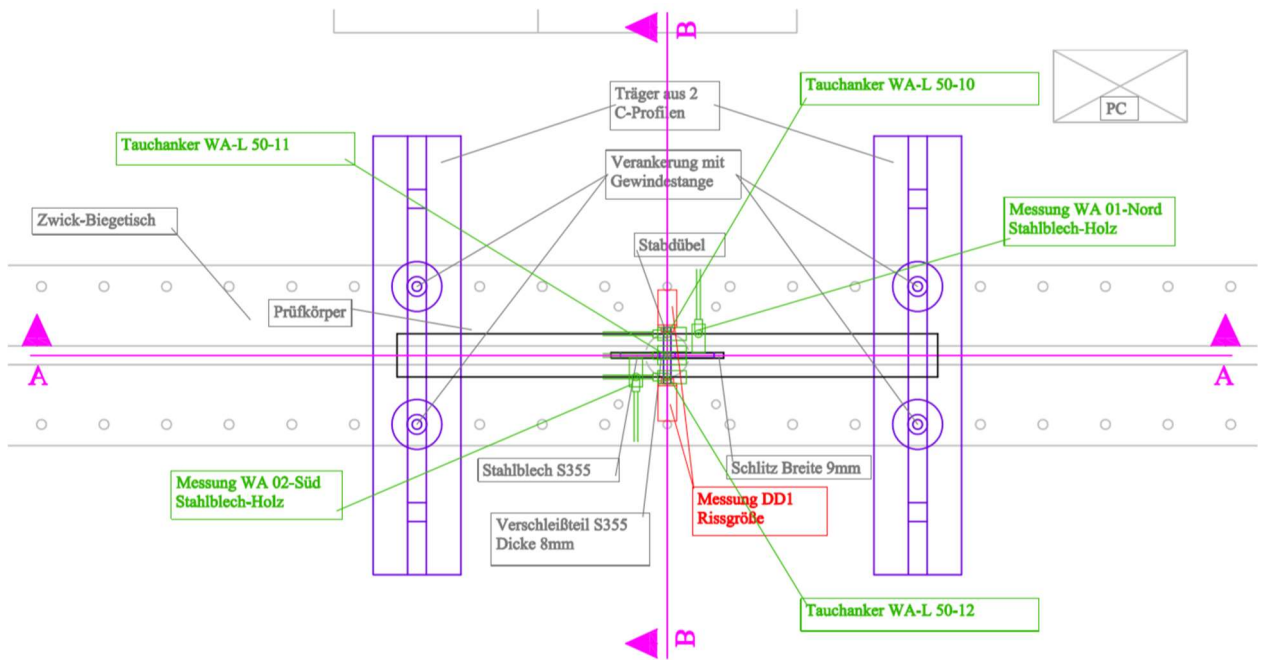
Grundriss Prüfaufbau
